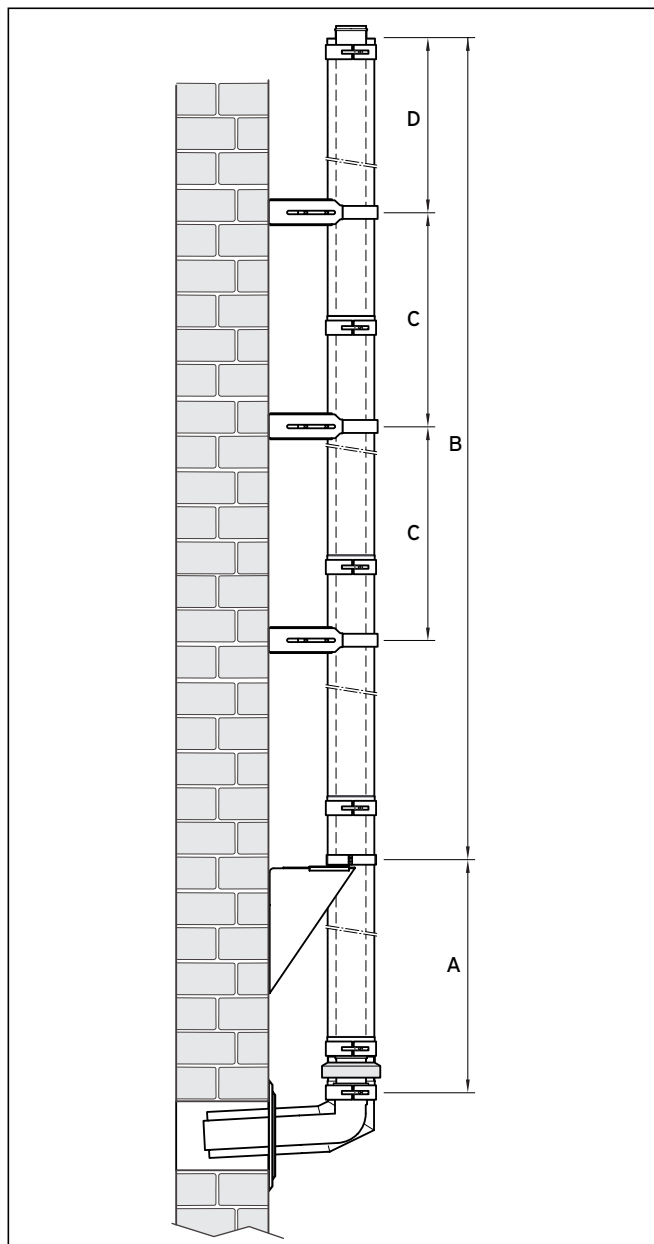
Prezentacja systemu przewodu spalinowego
